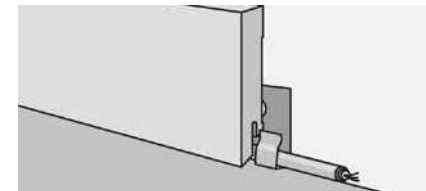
После укладки пола нужно вынуть фиксирующие клинья, а расширительные зазоры закрыть декоративным плинтусом. Плинтус крепится только к стене. Не допускается крепление плинтуса к напольному покрытию. Рекомендуем использовать для крепления специальные клипсы для плинтуса.
